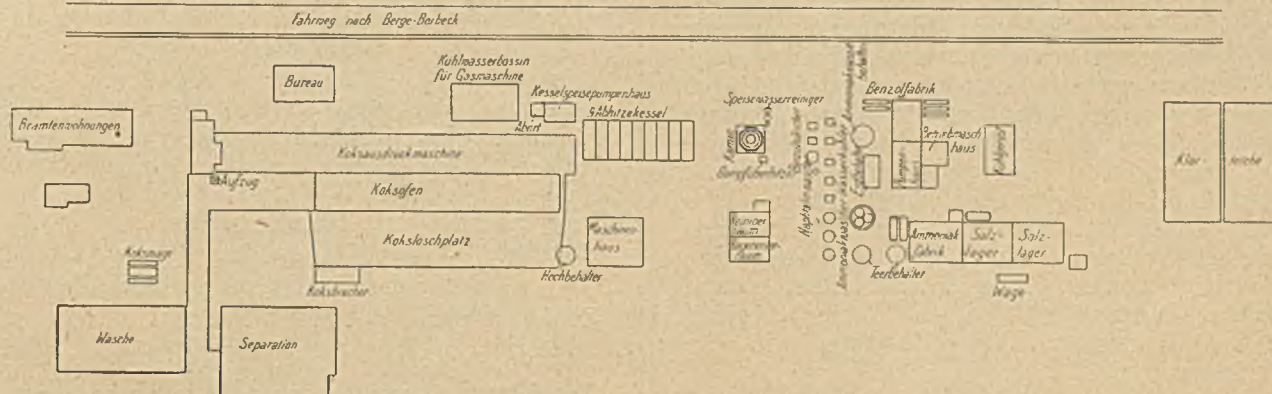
Lageplan der Kokerei mit Nebenproduktenfabrik auf Schachtanlage Emscher I/II.
